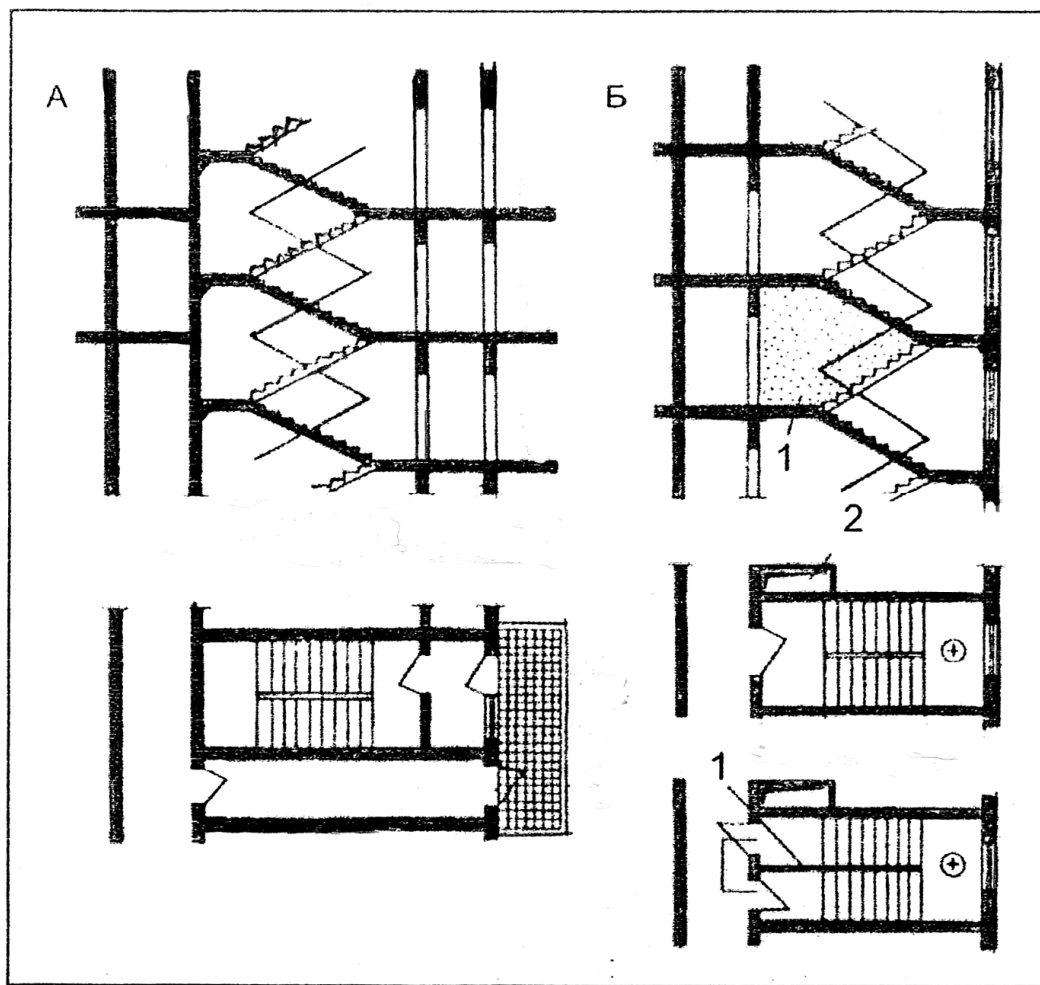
Незадымляемые лестницы для жилых домов 10 этажей и выше. А – с переходом через открытое пространство (балкон) – первый тип; Б-С подпором воздуха при пожаре (второй тип); 1 – несгораемая перегородка через пять этажей; 2 – канал для подпора воздуха
